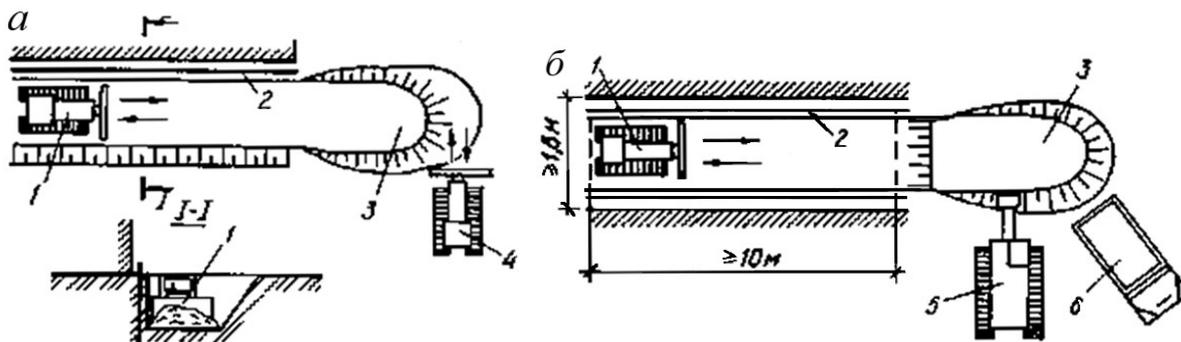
Разработка грунта бульдозером в стесненных условиях:
